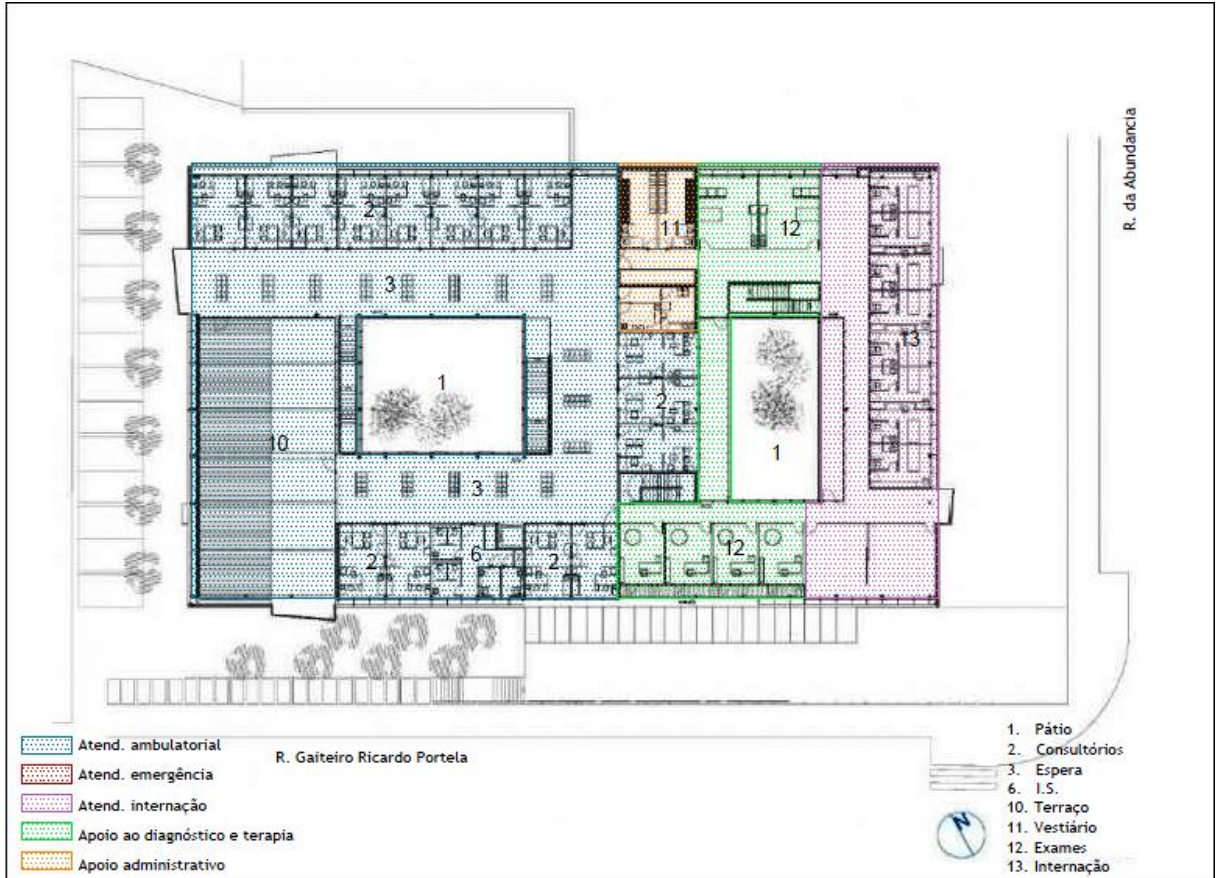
Planta pavimento superior (FONTE: ROSENBERG, 2011), adaptado
